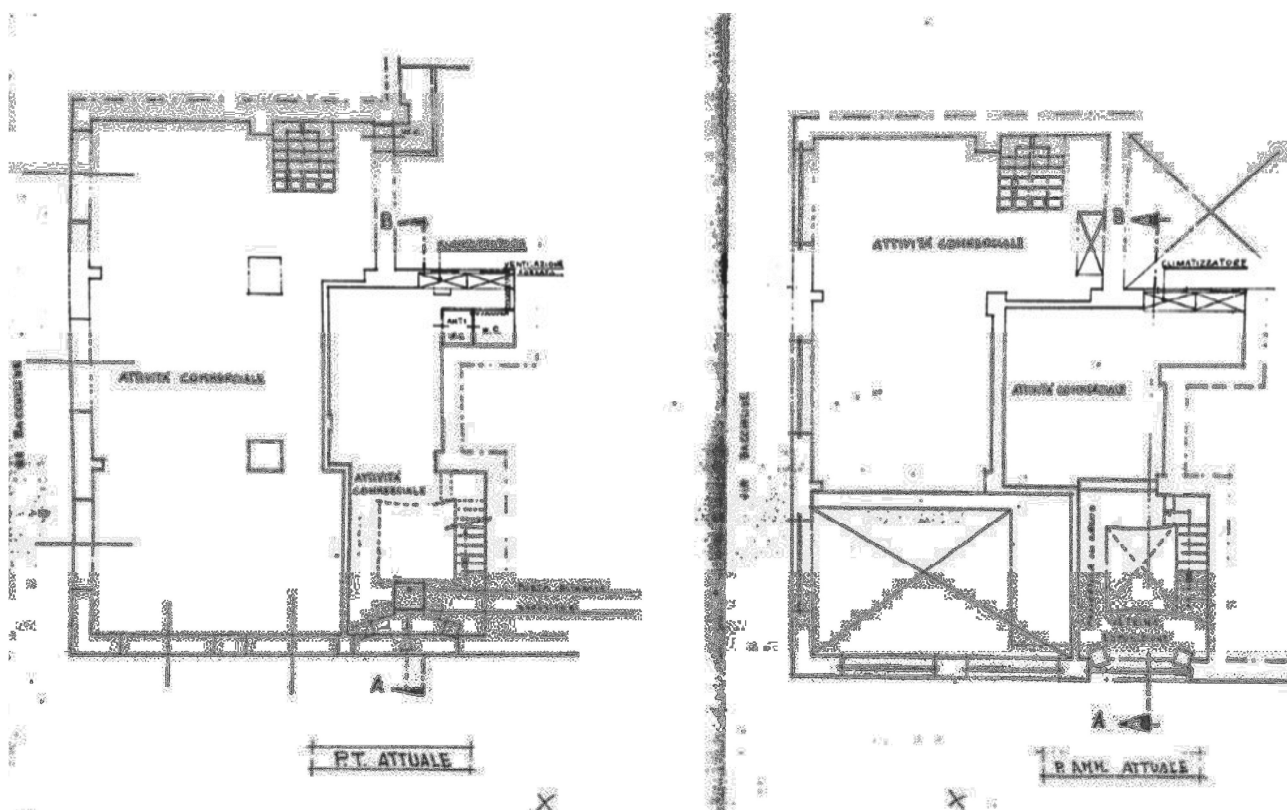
Planimetria Concessione Edilizia in Sanatoria 98/2001
